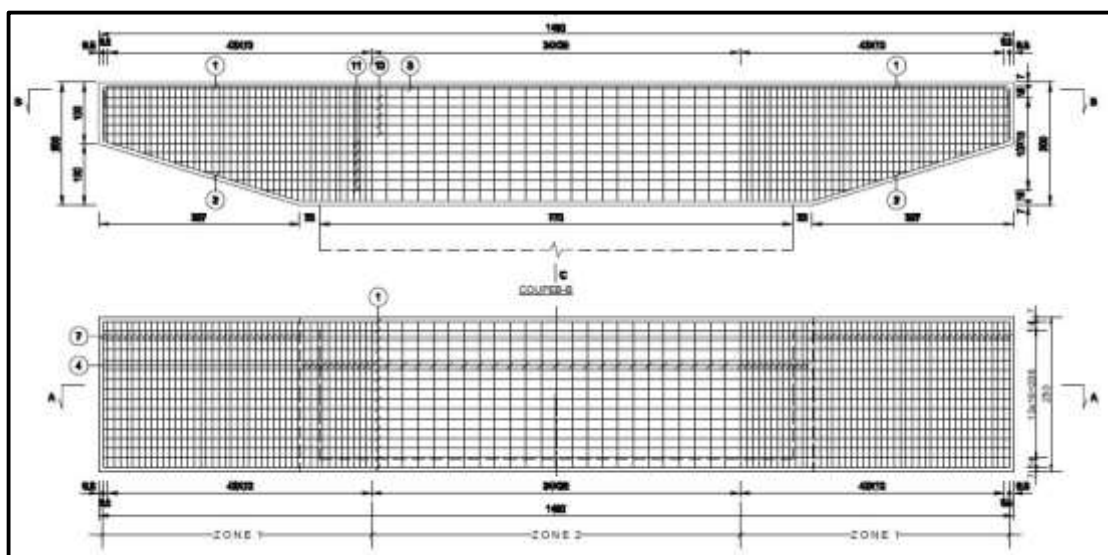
Plan de ferrailage du chevêtre de la pile P2-PK11+320
